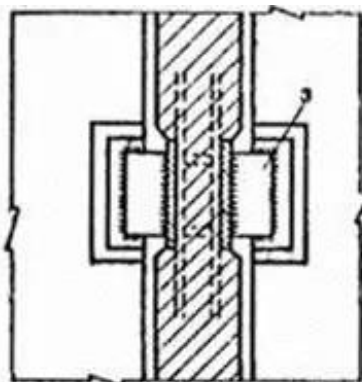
Общий вид сварного соединения вертикального стыка
